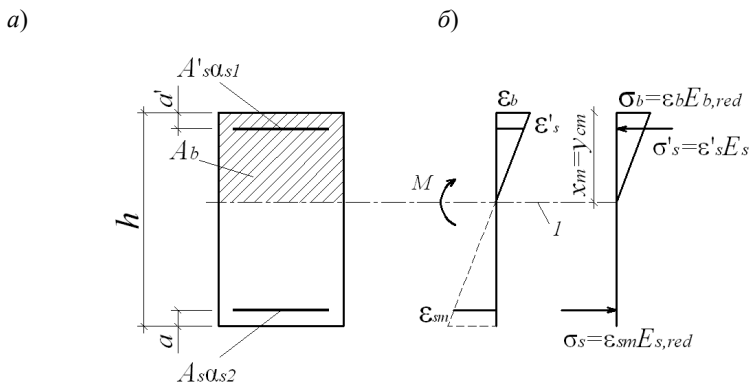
Приведенное поперечное сечение (а) и схема напряженно-деформированного состояния элемента с трещинами (б) для расчета его по деформациям при действии изгибающего момента
